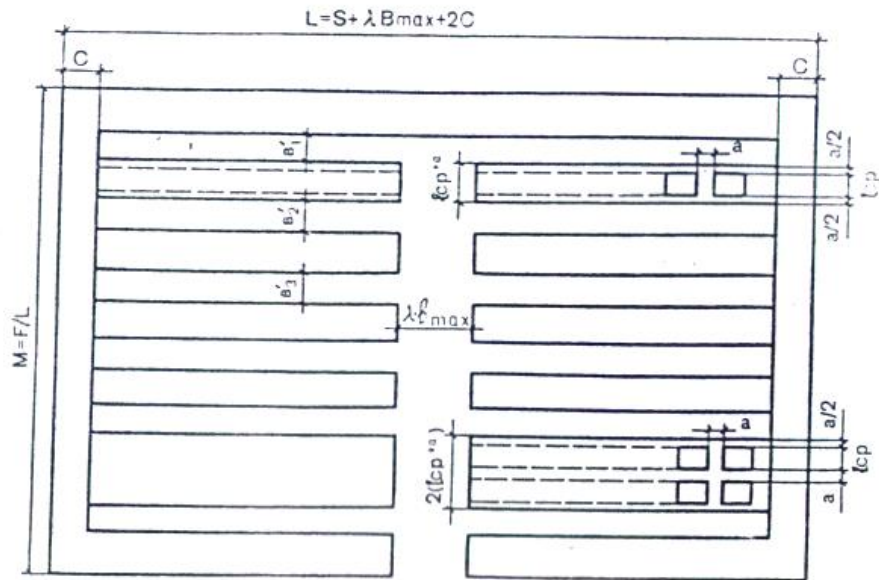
Схема двухрядного размещения машин на открытой площадке
